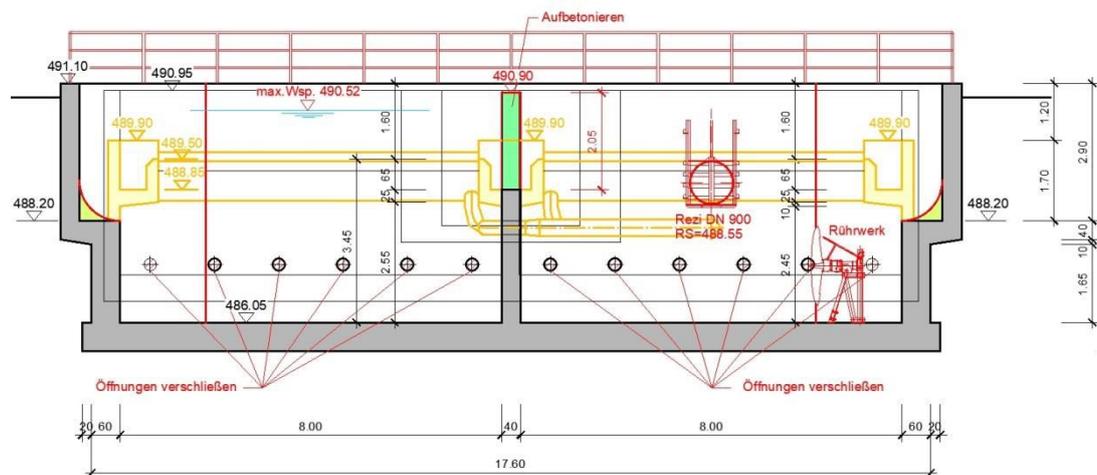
Geplante Umbauten „NKB zu DN-Becken“
